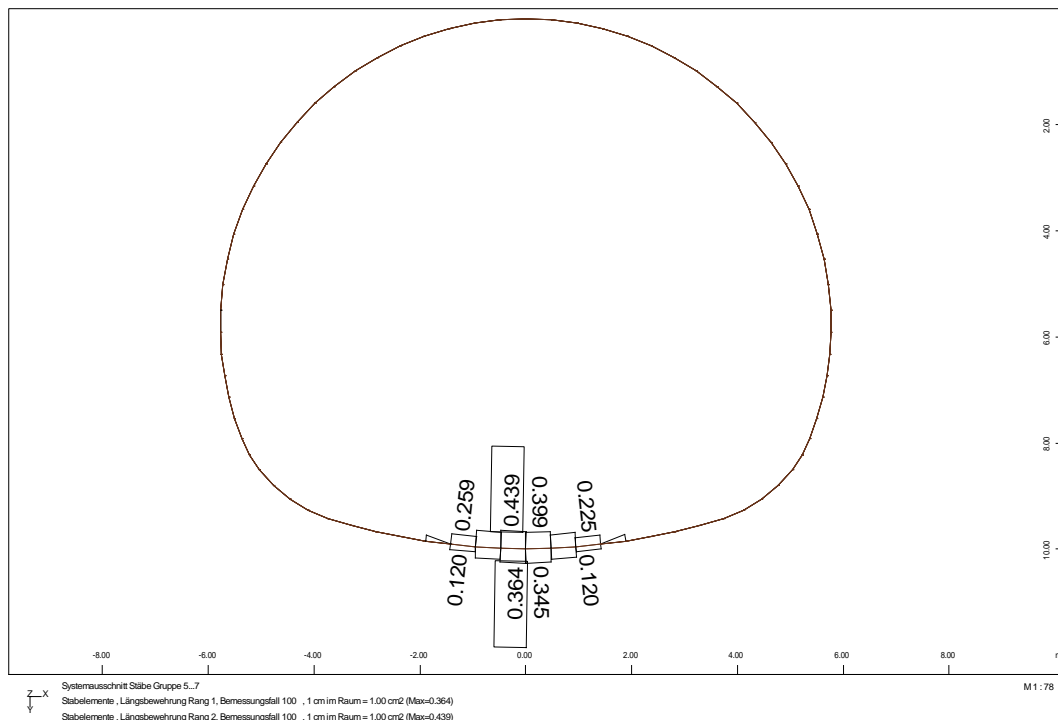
statisch erforderliche Biegebewehrung der Außenschale
